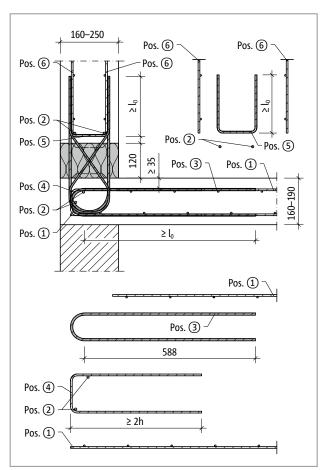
Schöck Isokorb® XT tipo A: Armadura in situ interior
